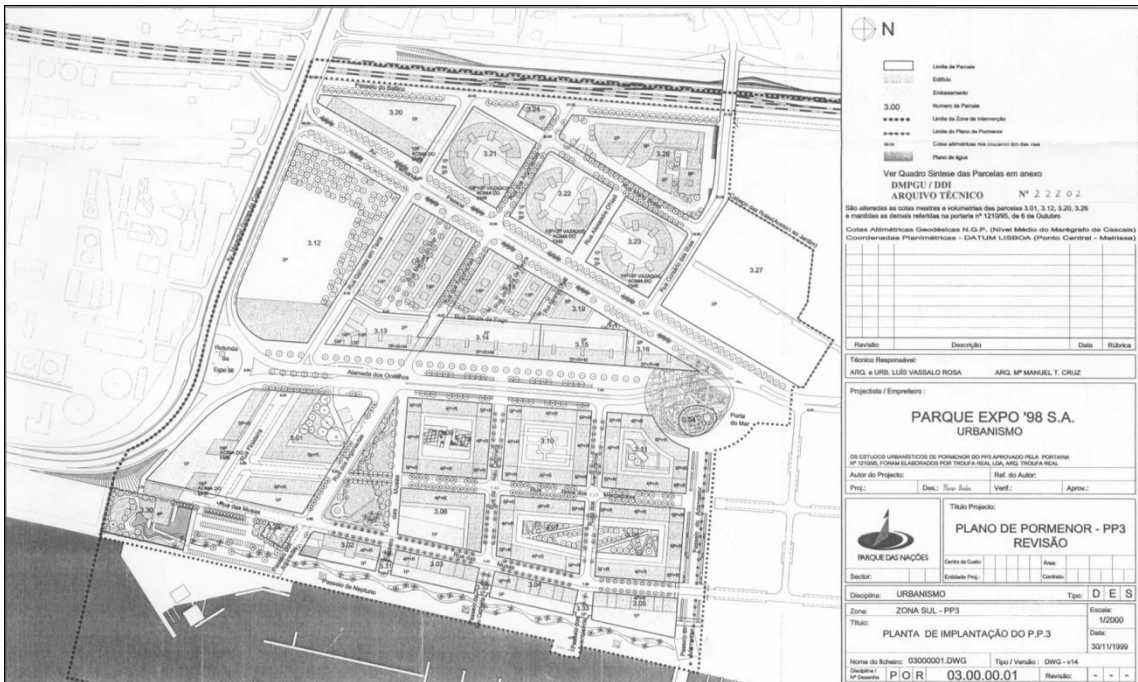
Planta do Plano de Pormenor n.º3: Zona da Avenida do Marechal Gomes da Costa
